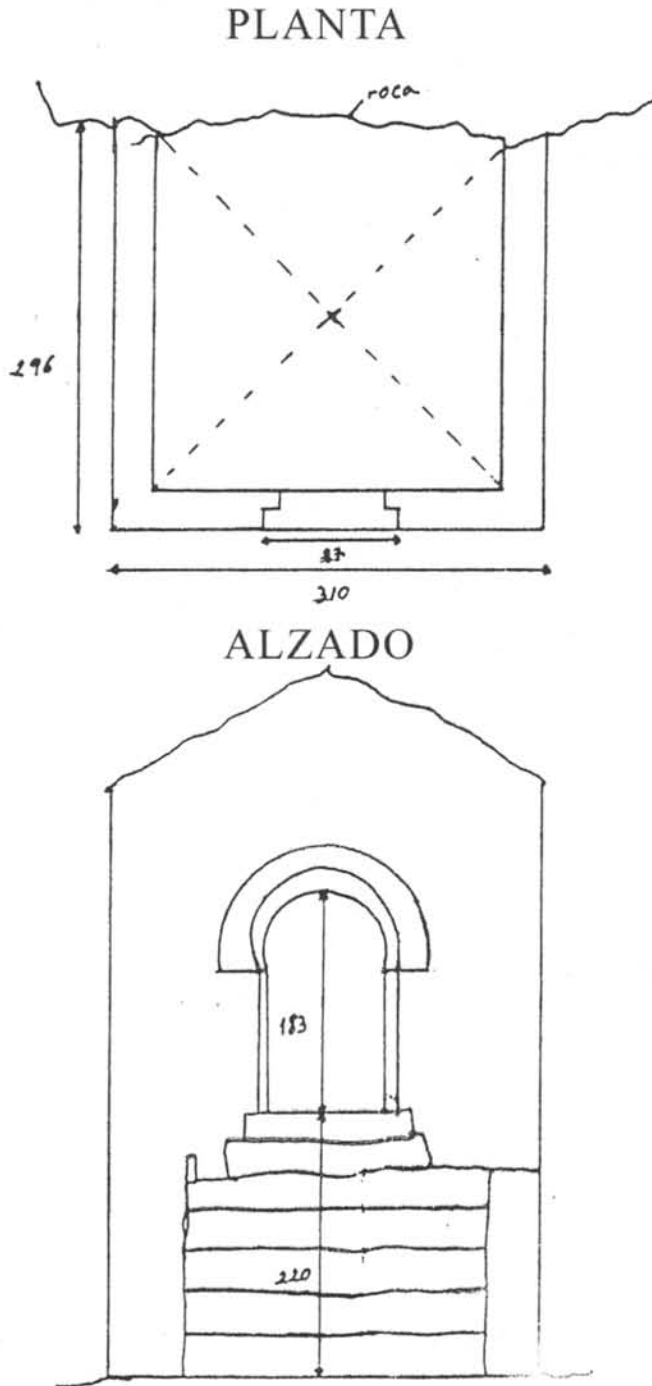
FIG. II. El aljibe de Daimalos. Planta y alzado (según Cabrera Ortí y Vilchez Vilchez).
